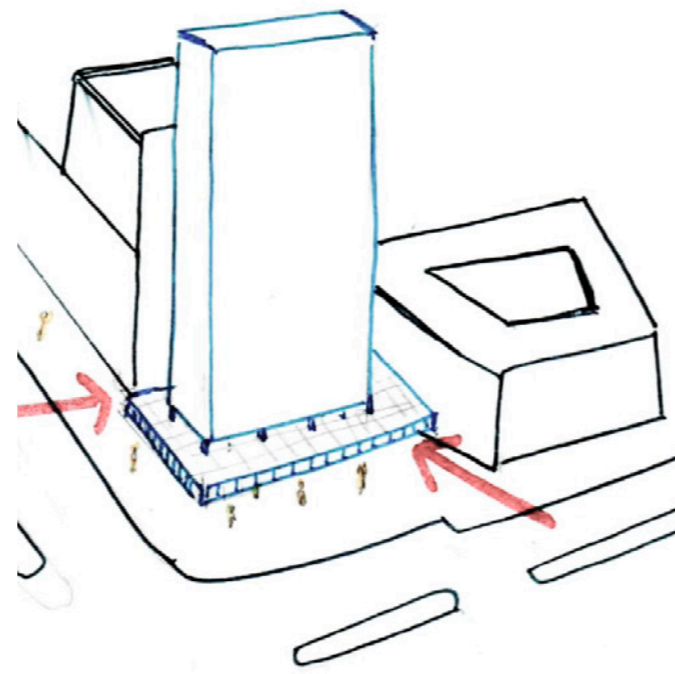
Permeabilidad a nivel de suelo, planta baja. Fuente propia
